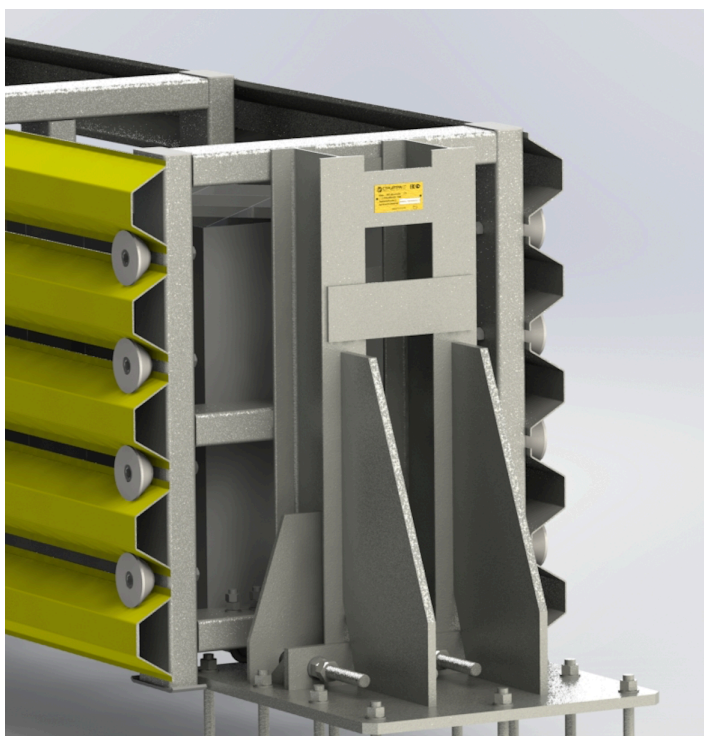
расположение маркировочной бирки на якорном устройстве.
